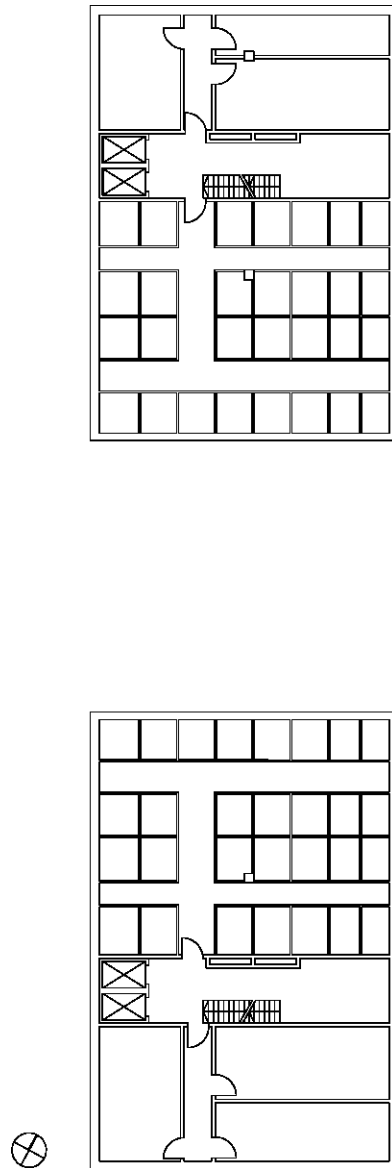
Grundrissvariante Erdgeschoss:
